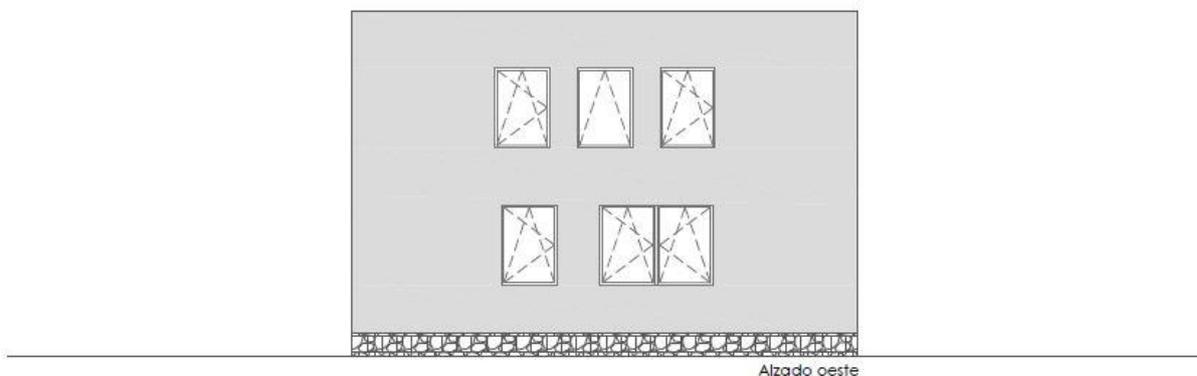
Alzado oeste de la vivienda. Fuente: Elaboración propia.
